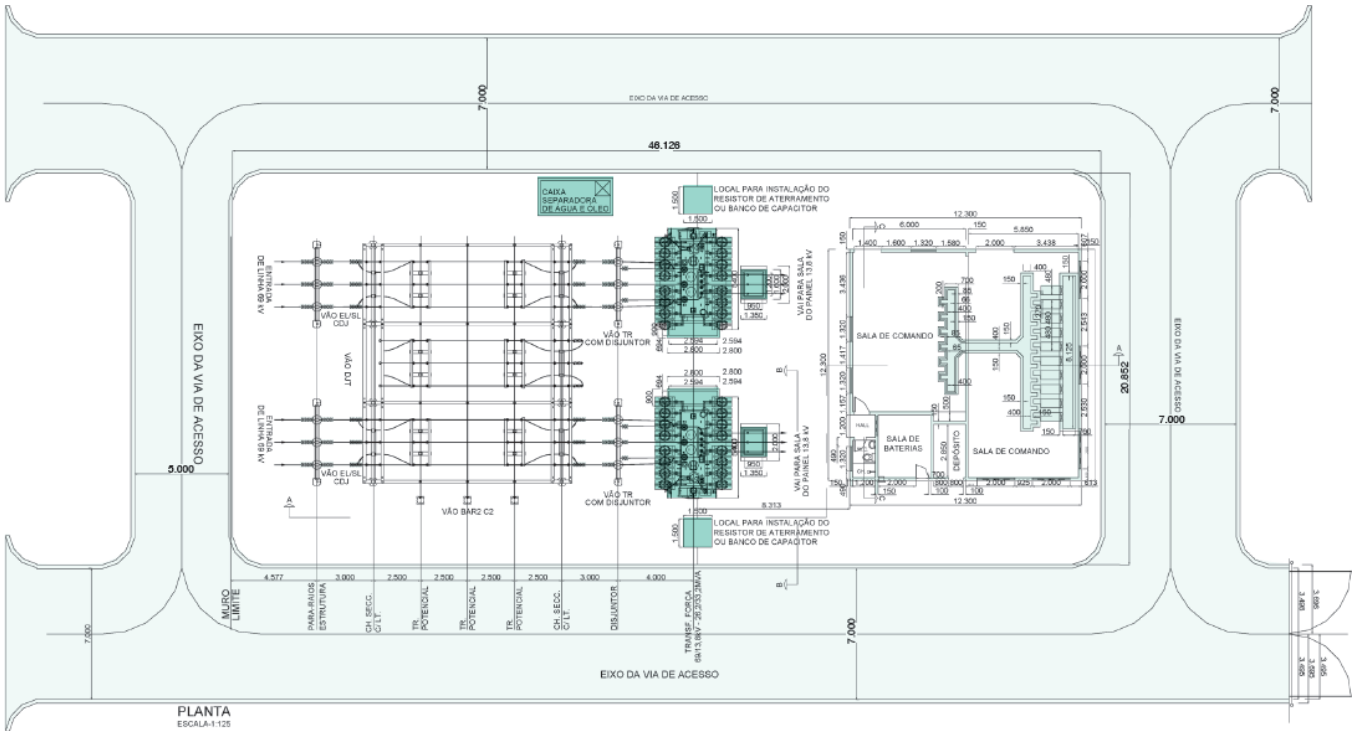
Planta baixa da subestação: duas linhas e dois transformadores.
